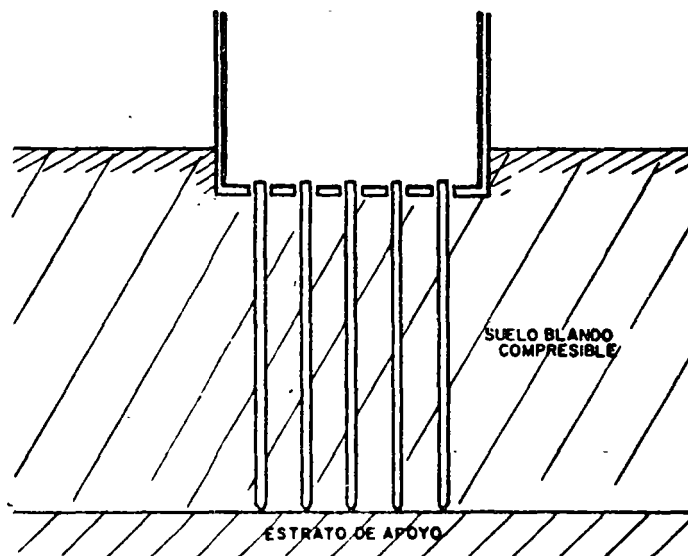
Pilotes de punta atravesando libremente la cimentación
